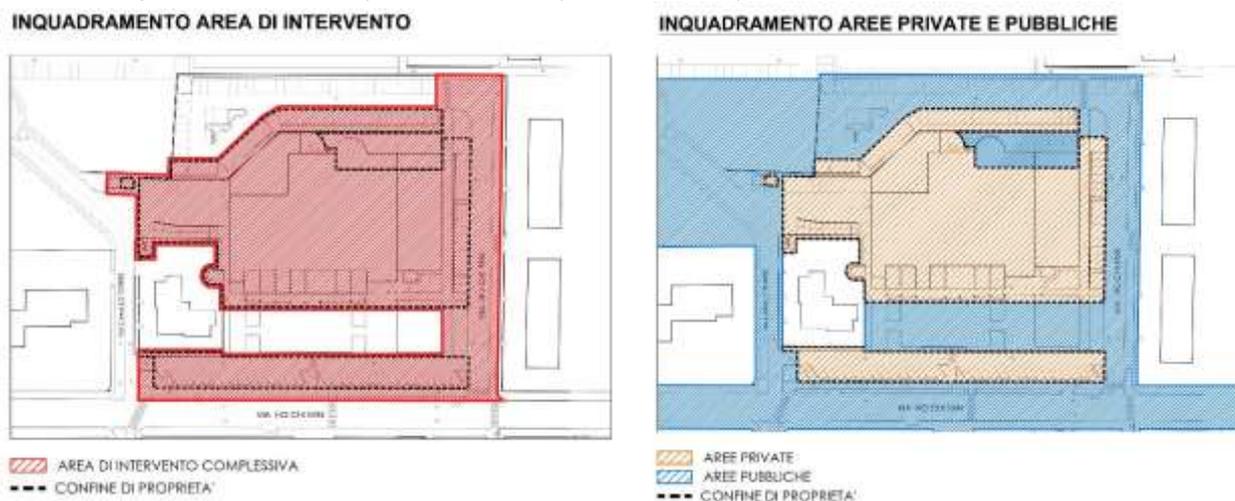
a – inquadramento dell'area di intervento (a sx) ed identificazione delle aree pubbliche e private di progetto oggetto di accordo (dx)
